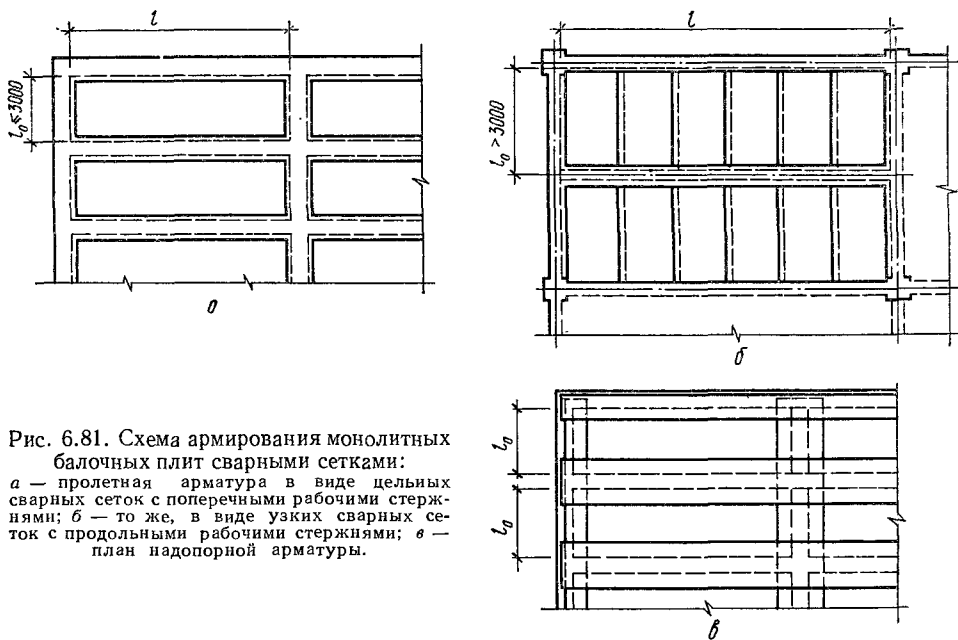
Схема армирования монолитных балочных плит сварными сетками:
